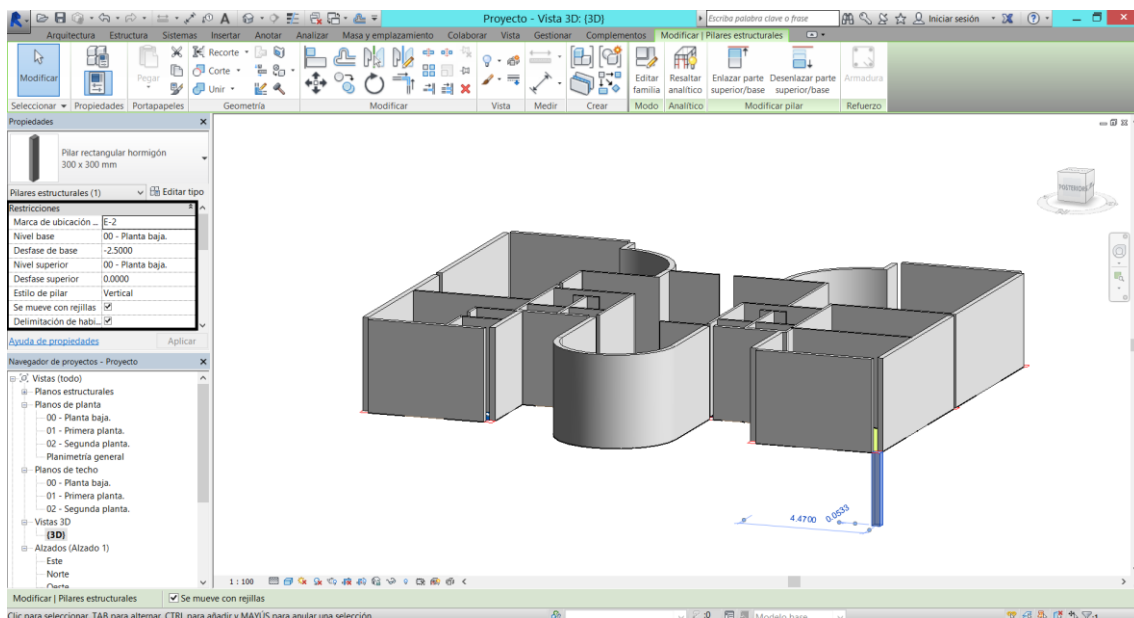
Restricciones del pilar. Fuente: Elaboración propia.
